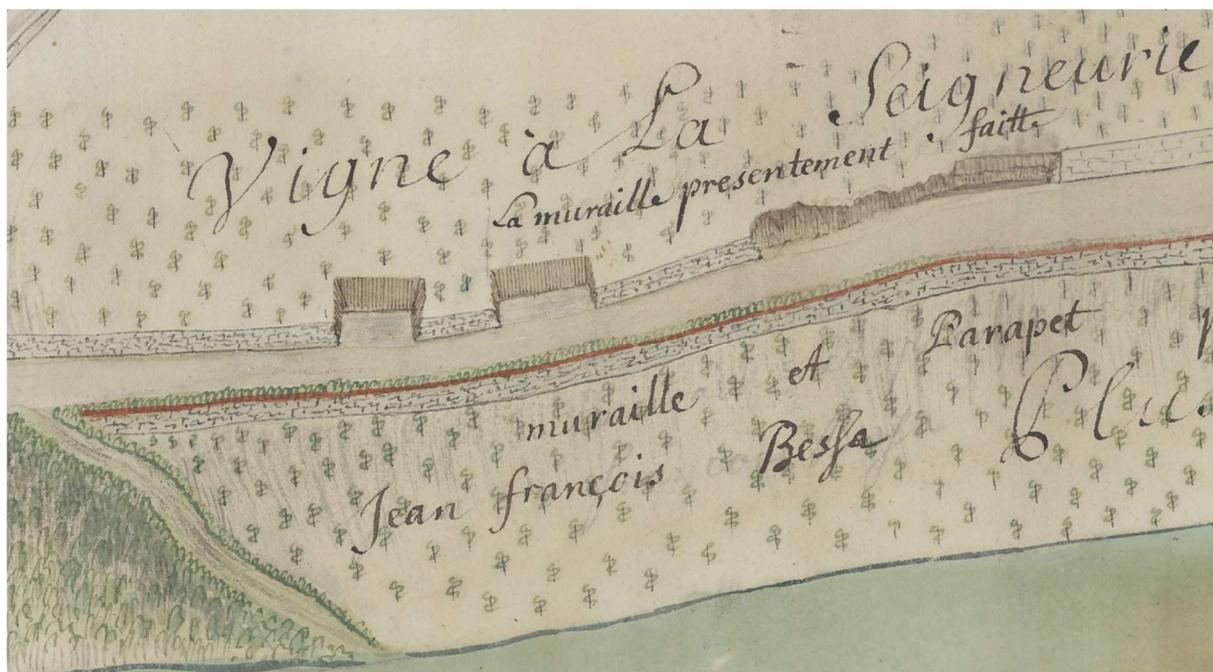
Détail plus rapproché du chantier des murs de parapet au Dézaley.
